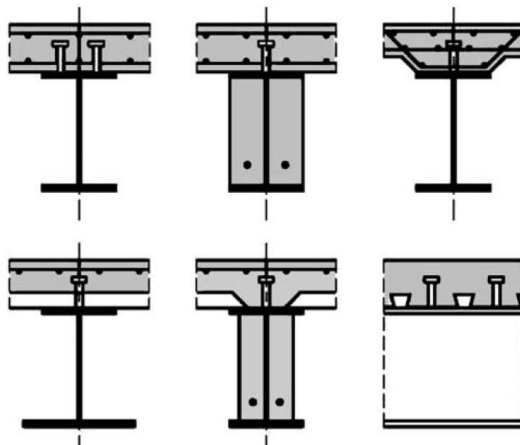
Основні типи поперечного перерізу сталезалізобетонних балок із залізобетонними плитами, що наведені в Eurocode 4
